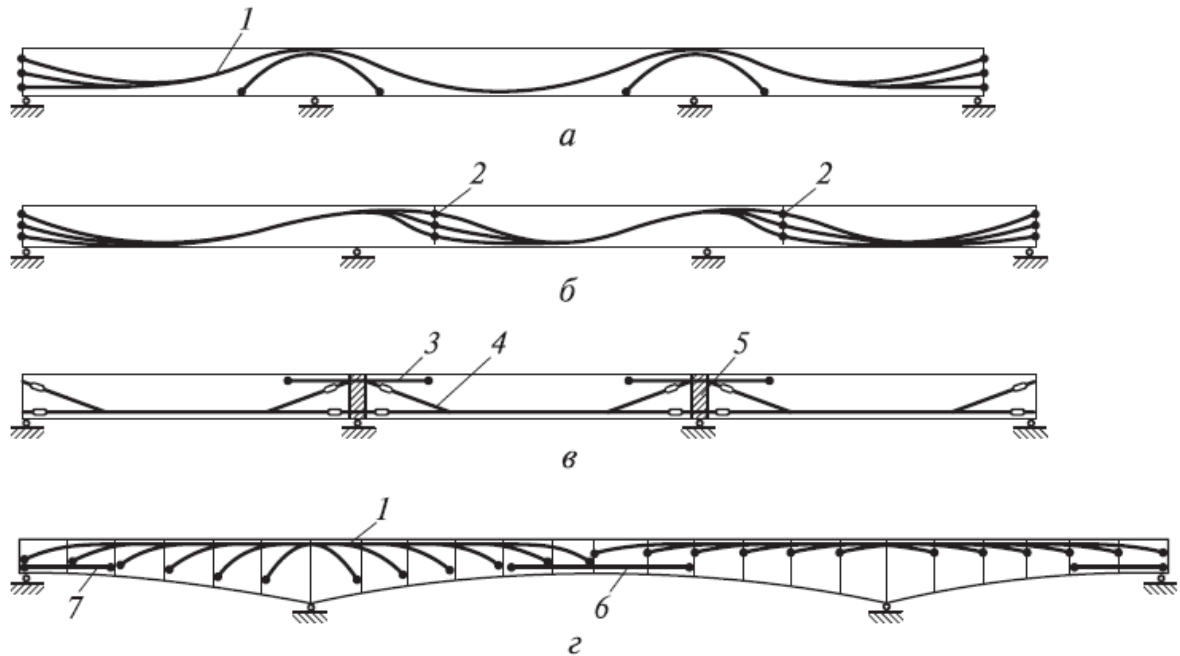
Варианты схем (а—г) армирования напрягаемой арматурой:
